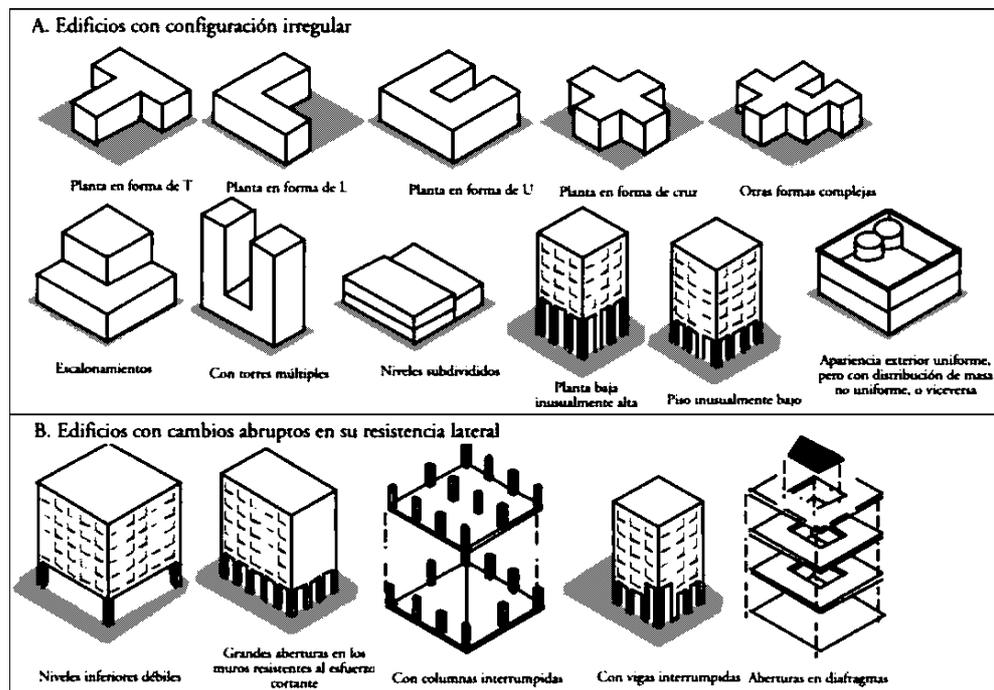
Tipos de simetrías en plantas. (LLOPIZ, 2014)
